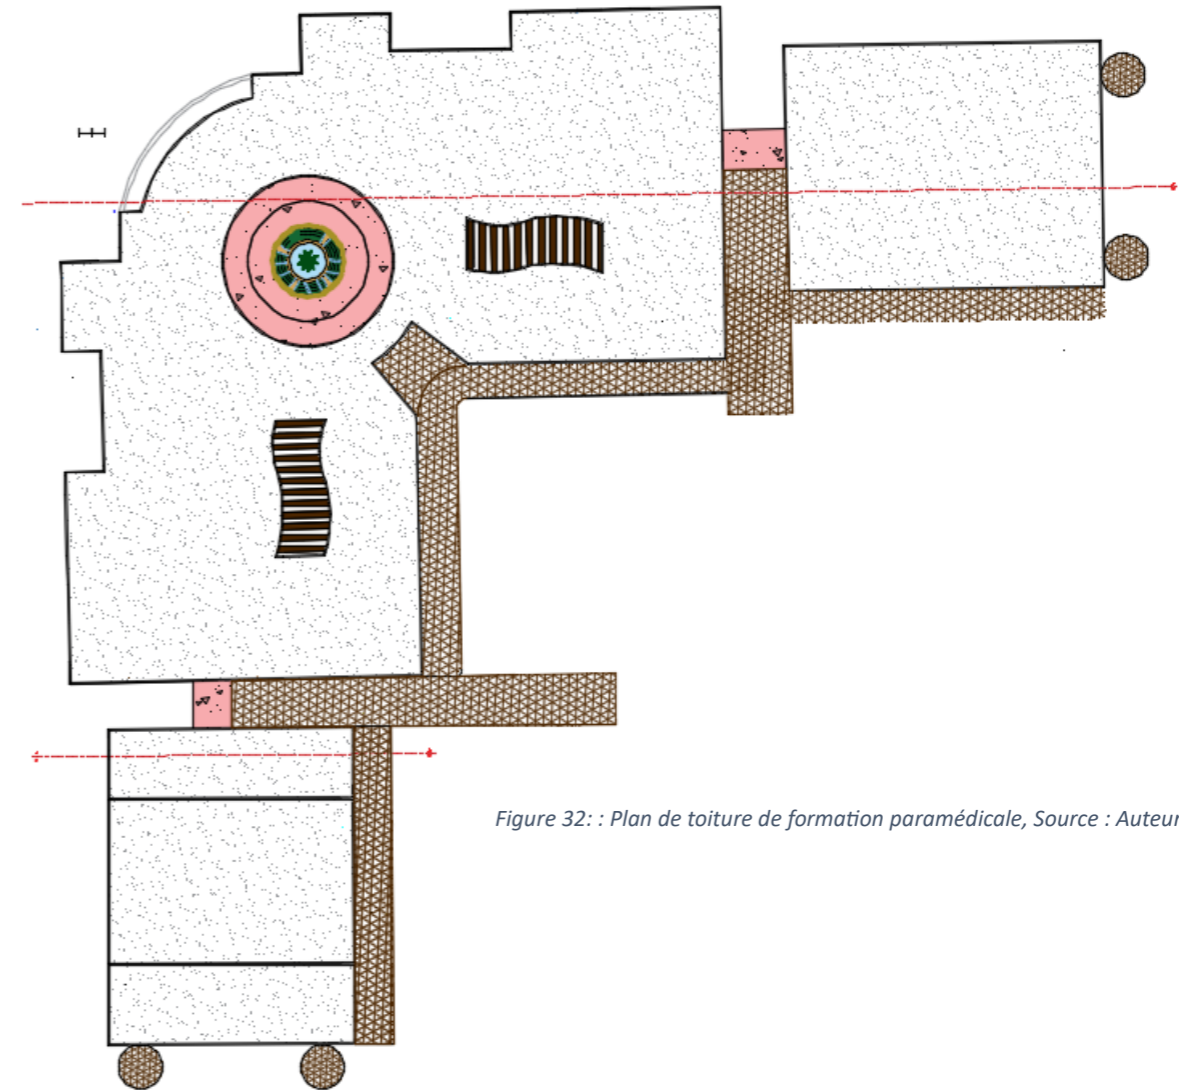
Plan de toiture de formation paramédicale, Source : Auteur
